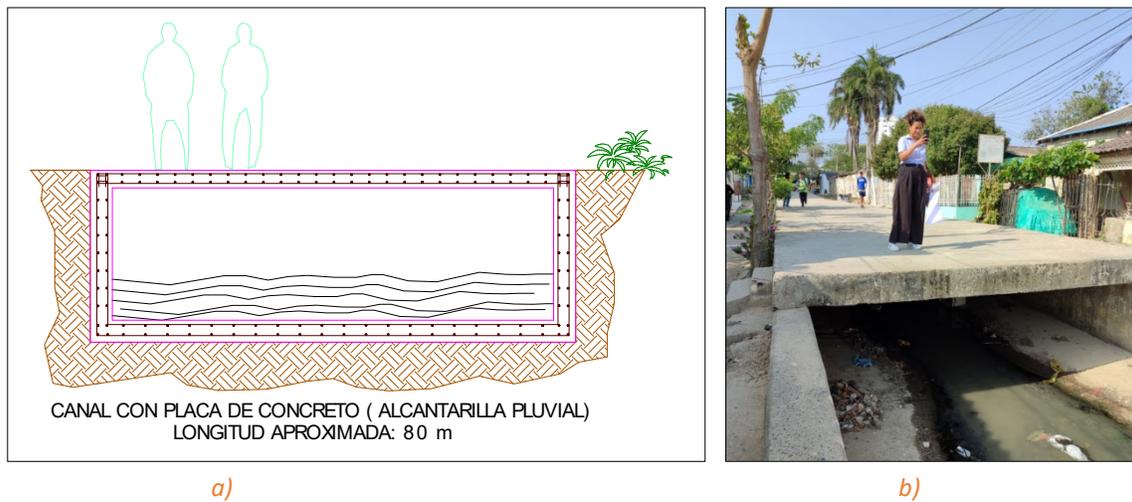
a) Sección transversal de canal con placa de concreto (Alcantarilla pluvial) b) fotografía de final del canal.
